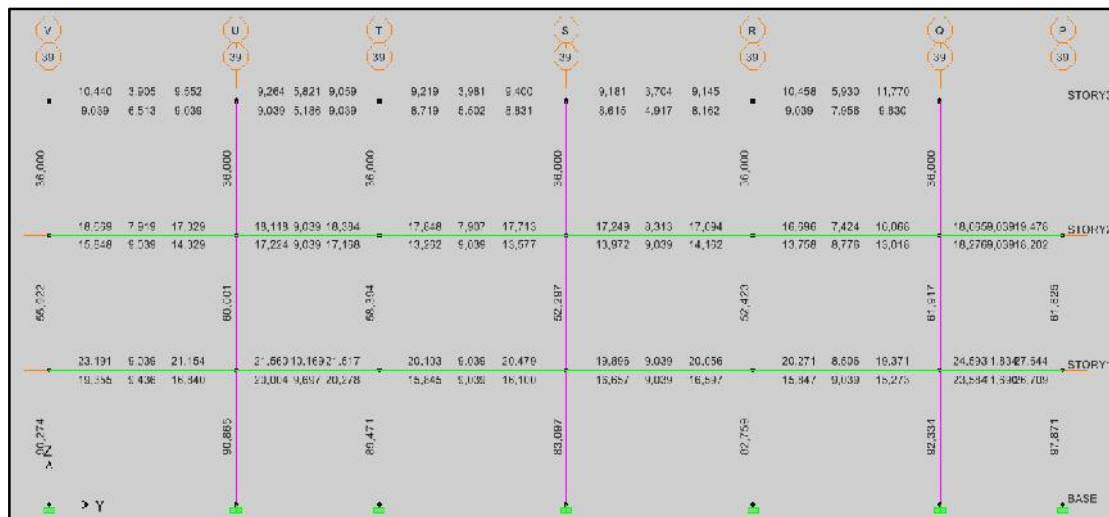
Acero en vigas pórtico 39, Consulta Externa I
